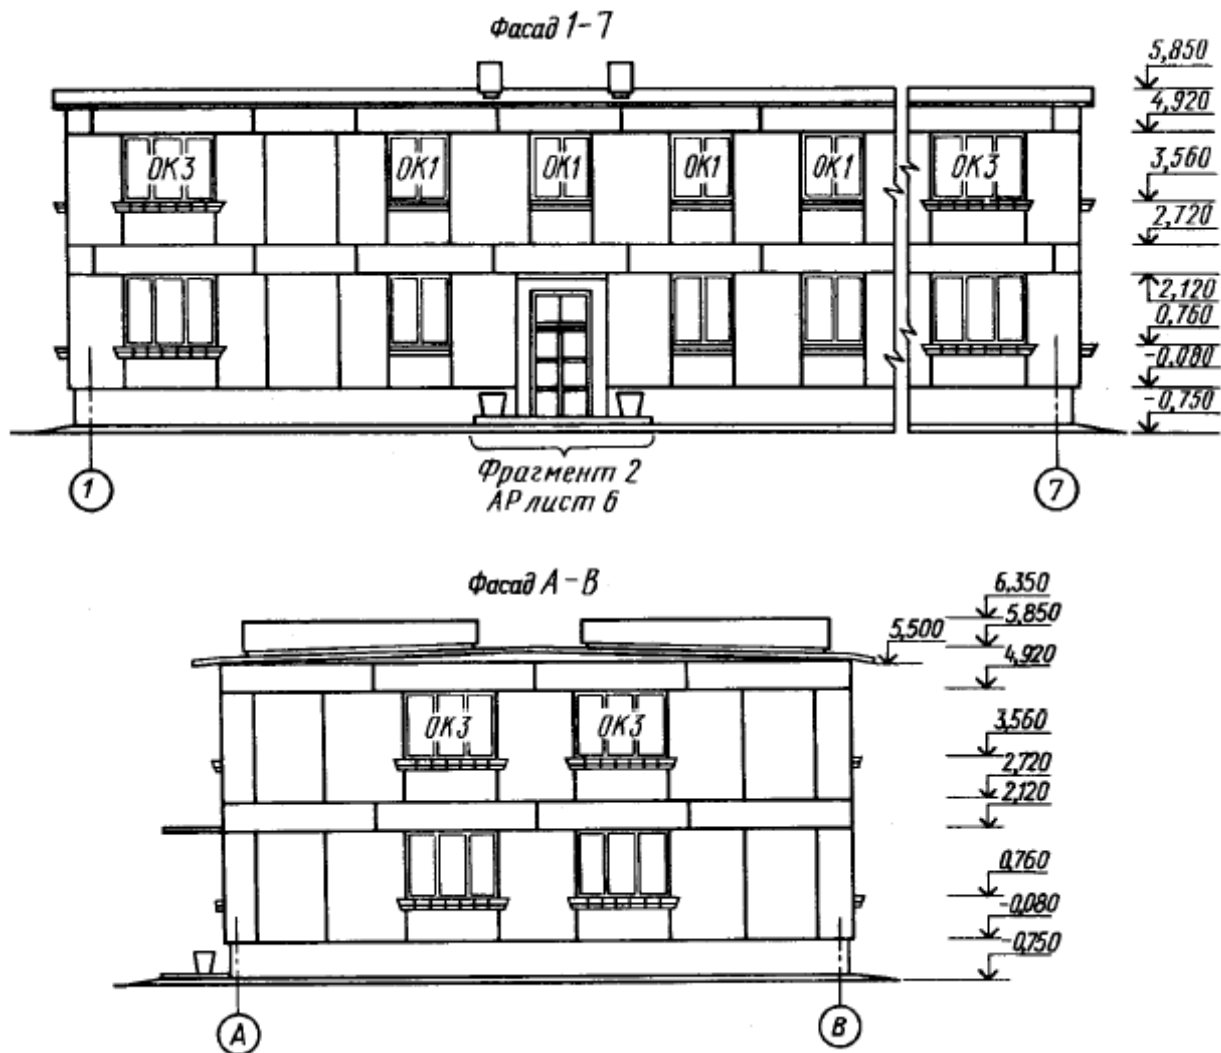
Фасад 1 – 7 и фасад А – В крупноблочного дома
